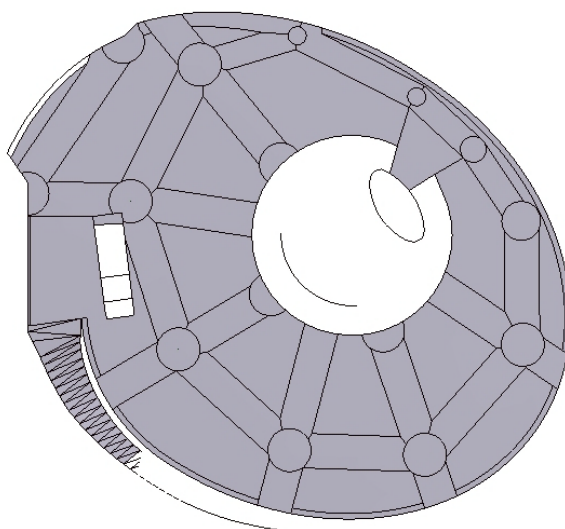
Corte parcial do modelo na Laje do Piso 2
